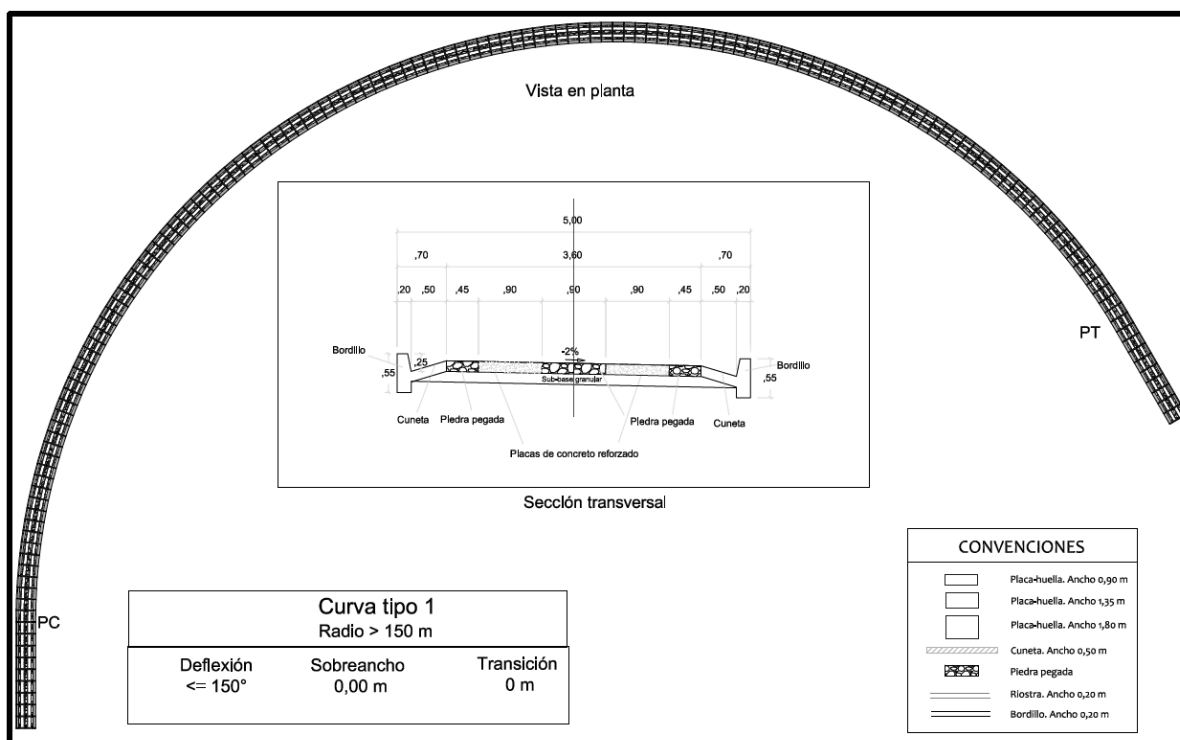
Vista en planta y perfil de la sección transversal en curvas TIPO 1 Δ ≤ 150° y R > 150 m
